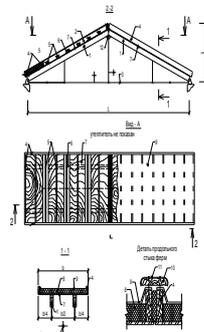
Простейшая пространственная ферма: 1 - основные ребра верхнего пояса; 2 - клеефанерный щит; 3 - стальной нижний пояс; 4 - фанерная обшивка; 5 - соединительные ребра; 6 - деревянные элементы конструкции; 7 - обшивка; 8 - утеплитель; 9 - рубероидный ковер; 10 - гидроизоляция; 11 - цементно-песчаный слой; 12 - цементно-песчаный слой.
